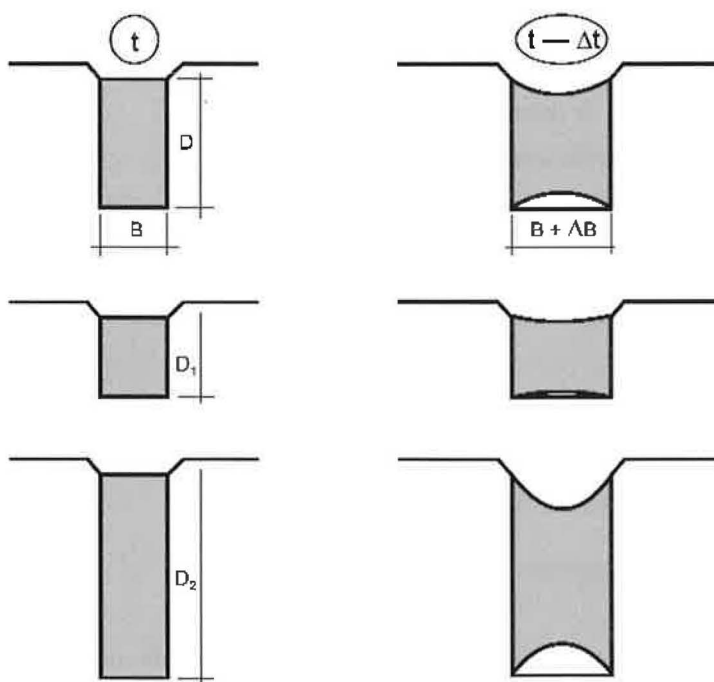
Relation entre la profondeur et la largeur de la saignée
